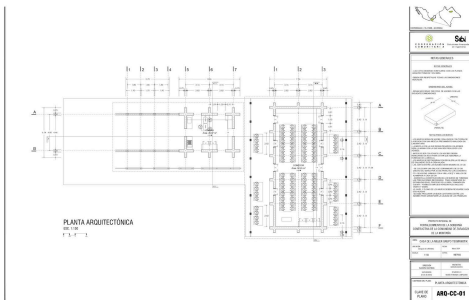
Planta arquitectónica (ARQ-CC-01)
